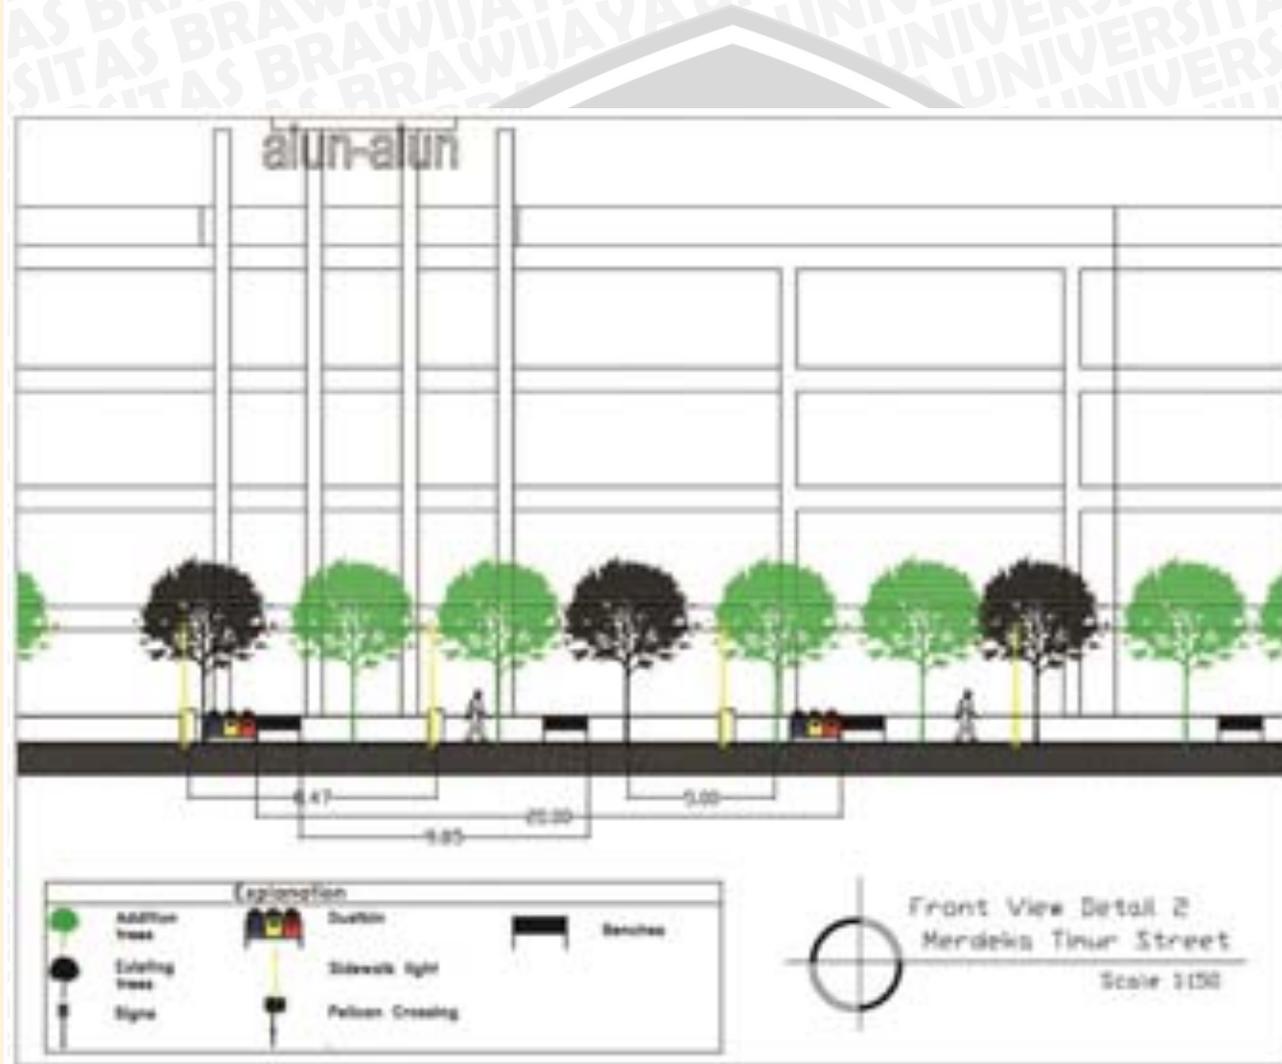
75 Detail Potongan Jalan Merdeka Timur
